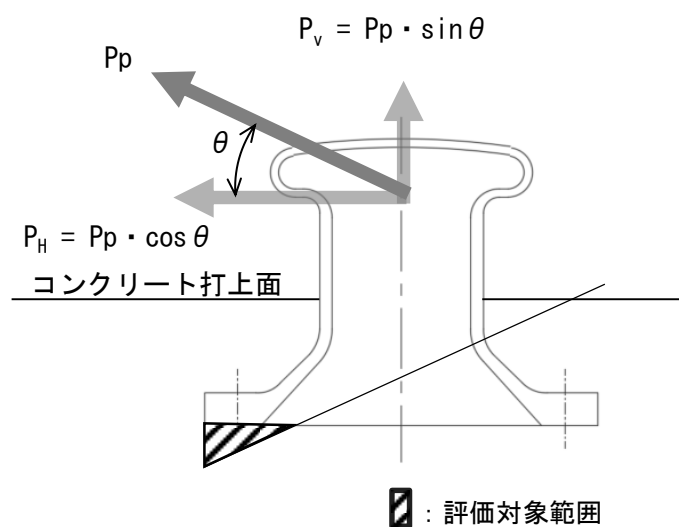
コンクリート（係船柱底板）のモデル図
